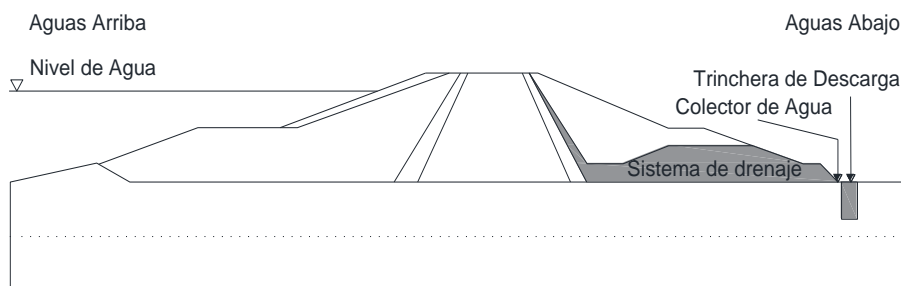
Sistema de drenaje e infiltración de un bordo
